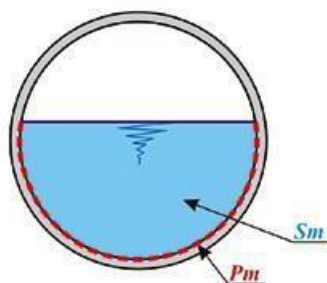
Section transversale d'un ouvrage d'assainissement.
